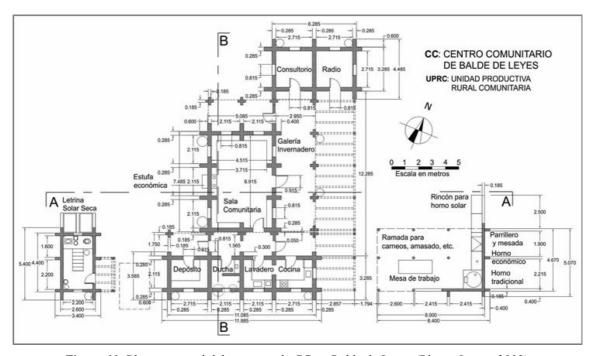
Planta general del proyecto de CC en Balde de Leyes (Blasco Lucas, 2013).
